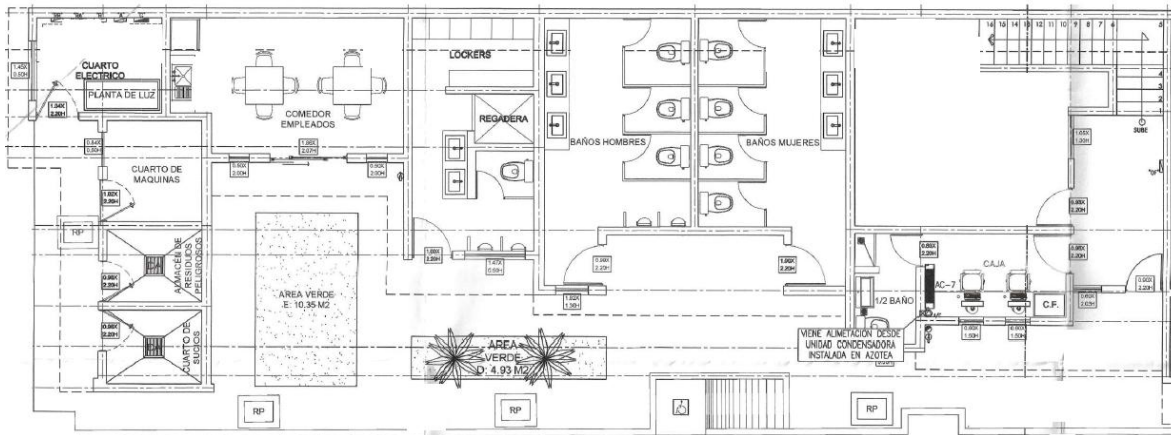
PLANO DE DISTRIBUCION PLANTA BAJA
